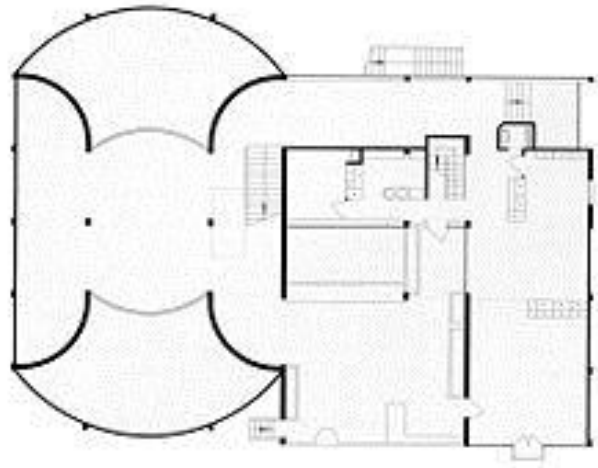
Pabellón de L'Esprit Nouveau. Primera planta. Fuente: <http://www.urbipedia.org/>
